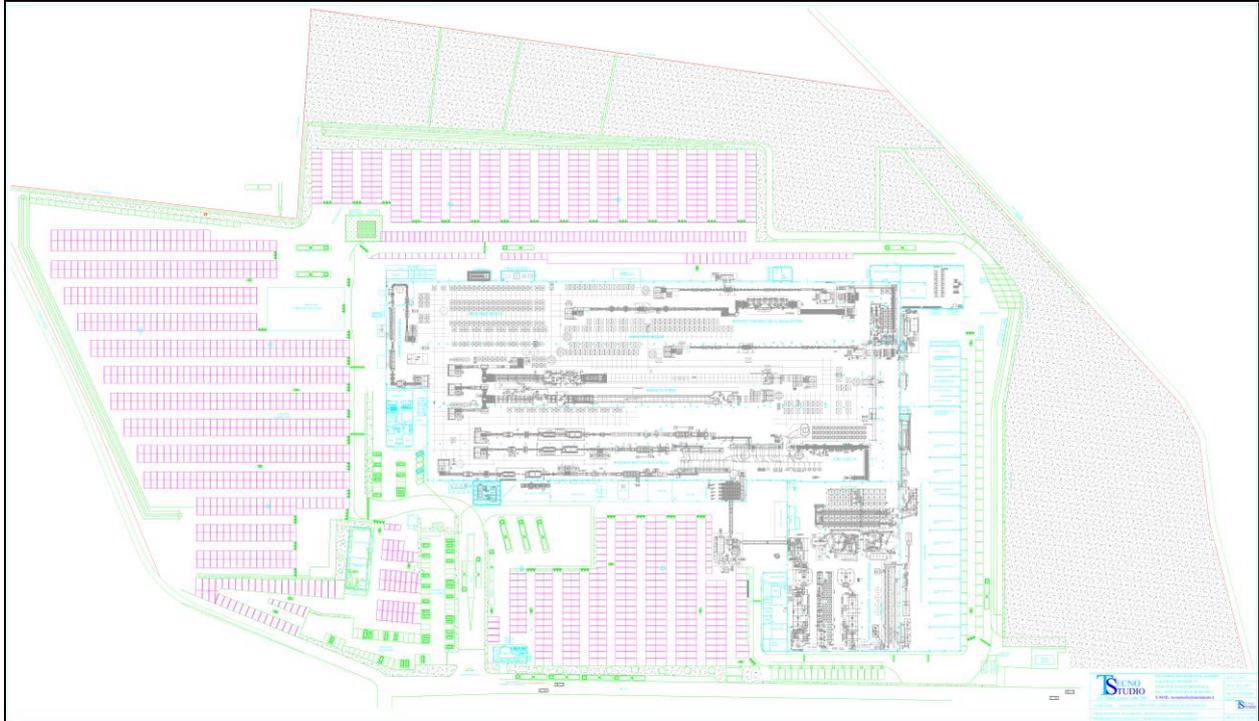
estratto della planimetria dello stato attuale dello stabilimento
